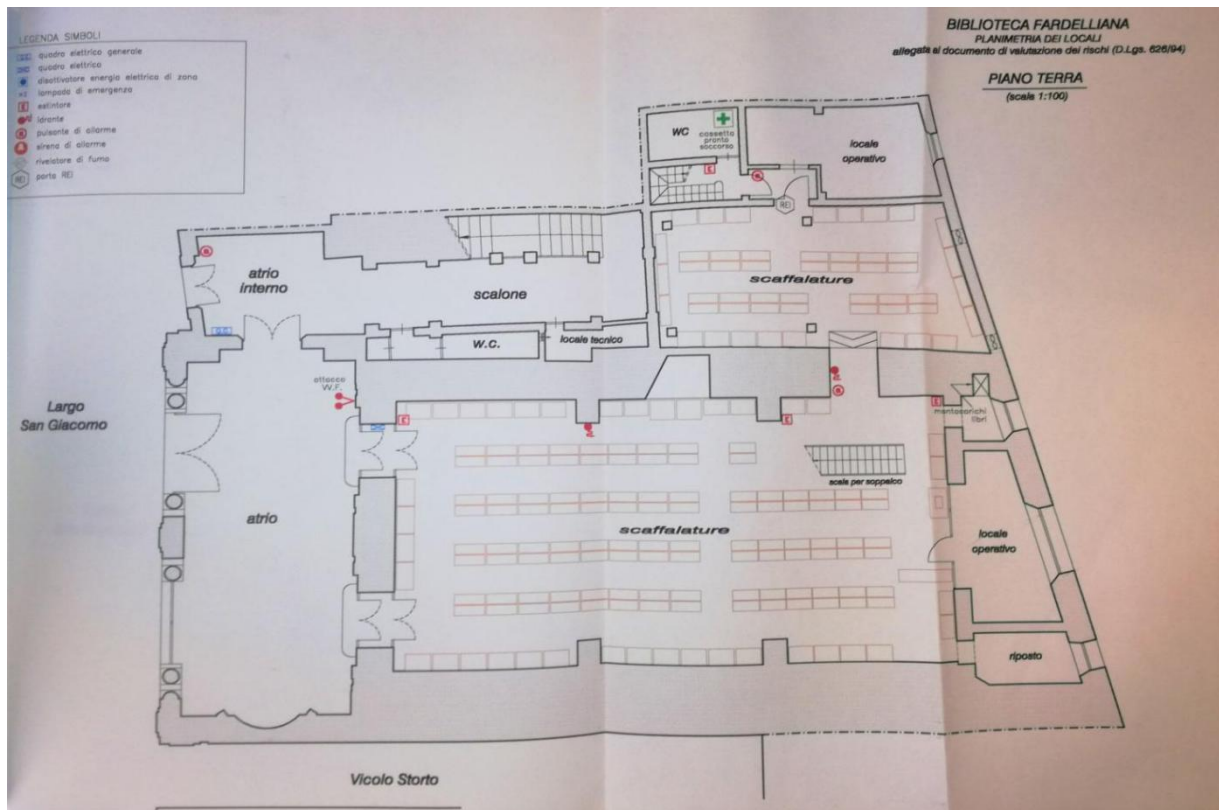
Planimetria Piano Terra della 'Biblioteca Fardelliana'
